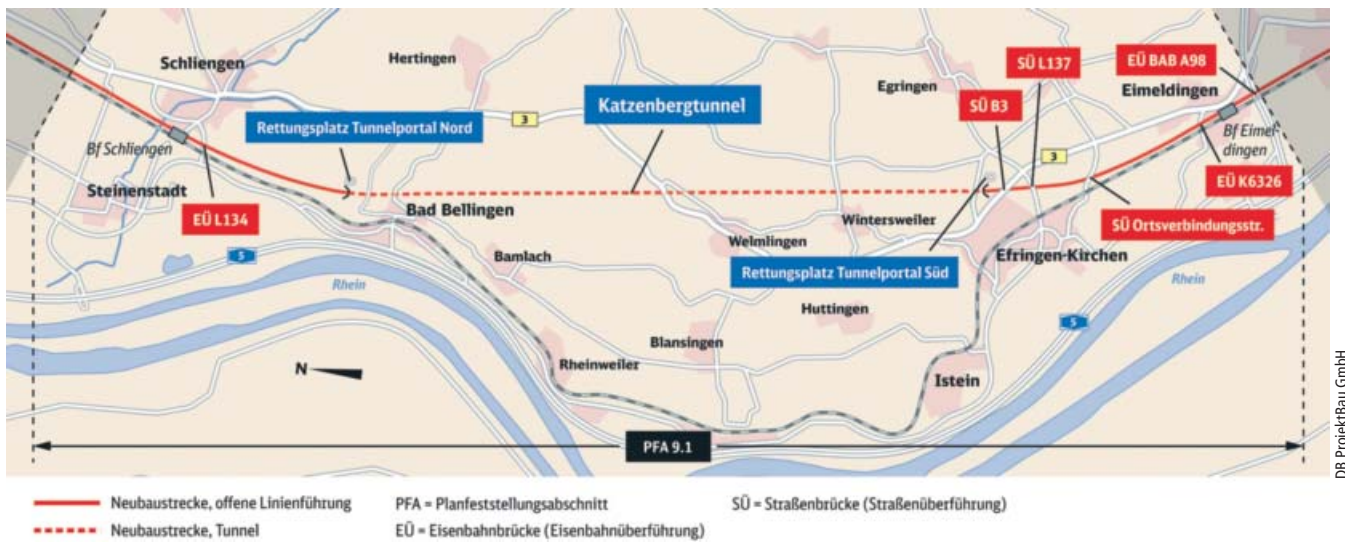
Der Planfeststellungsabschnitt (PFA) 9.1 mit Katzenbergtunnel
